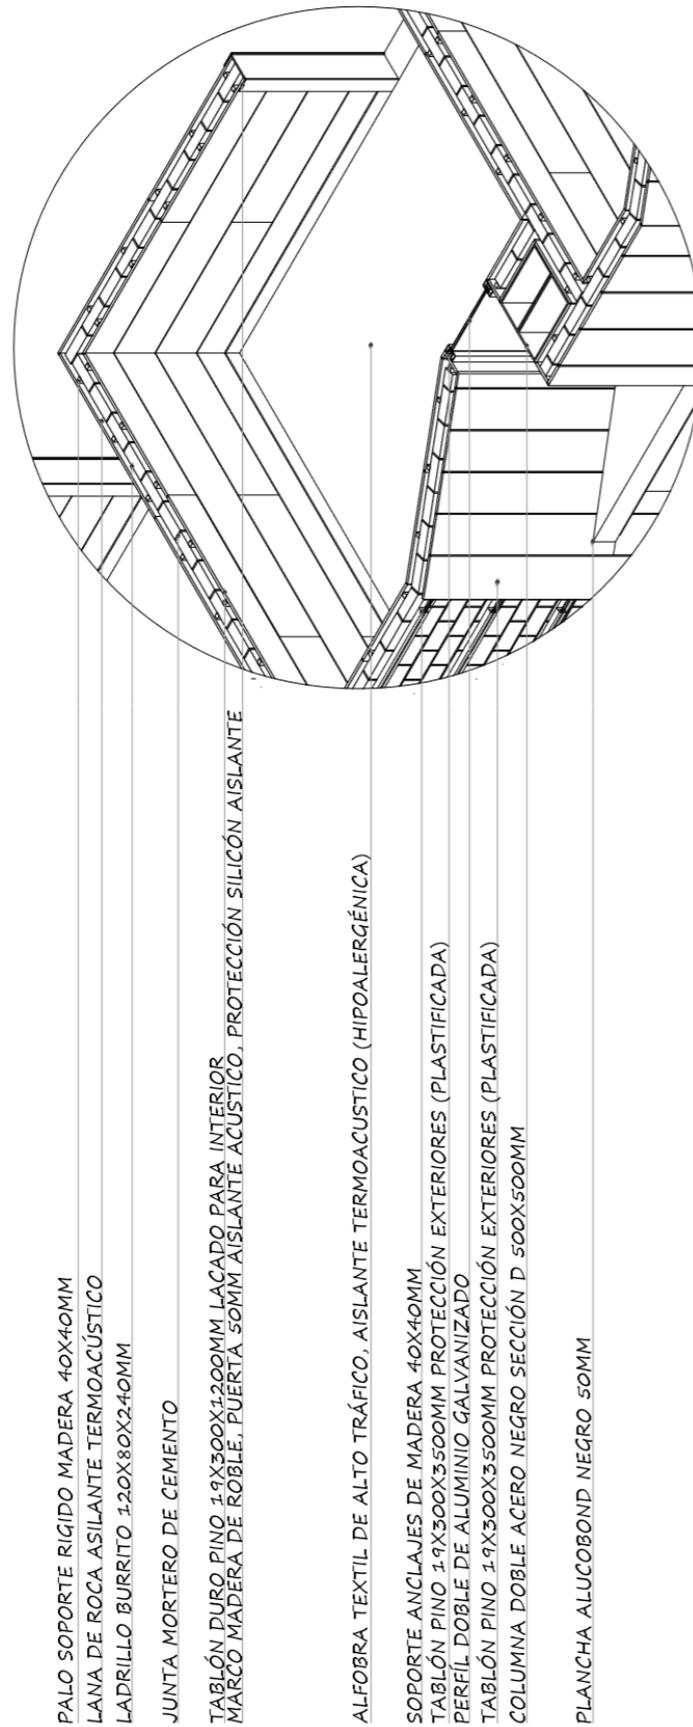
Detalle constructivo, en el volumen superior de aulas. (Elemento propio).
